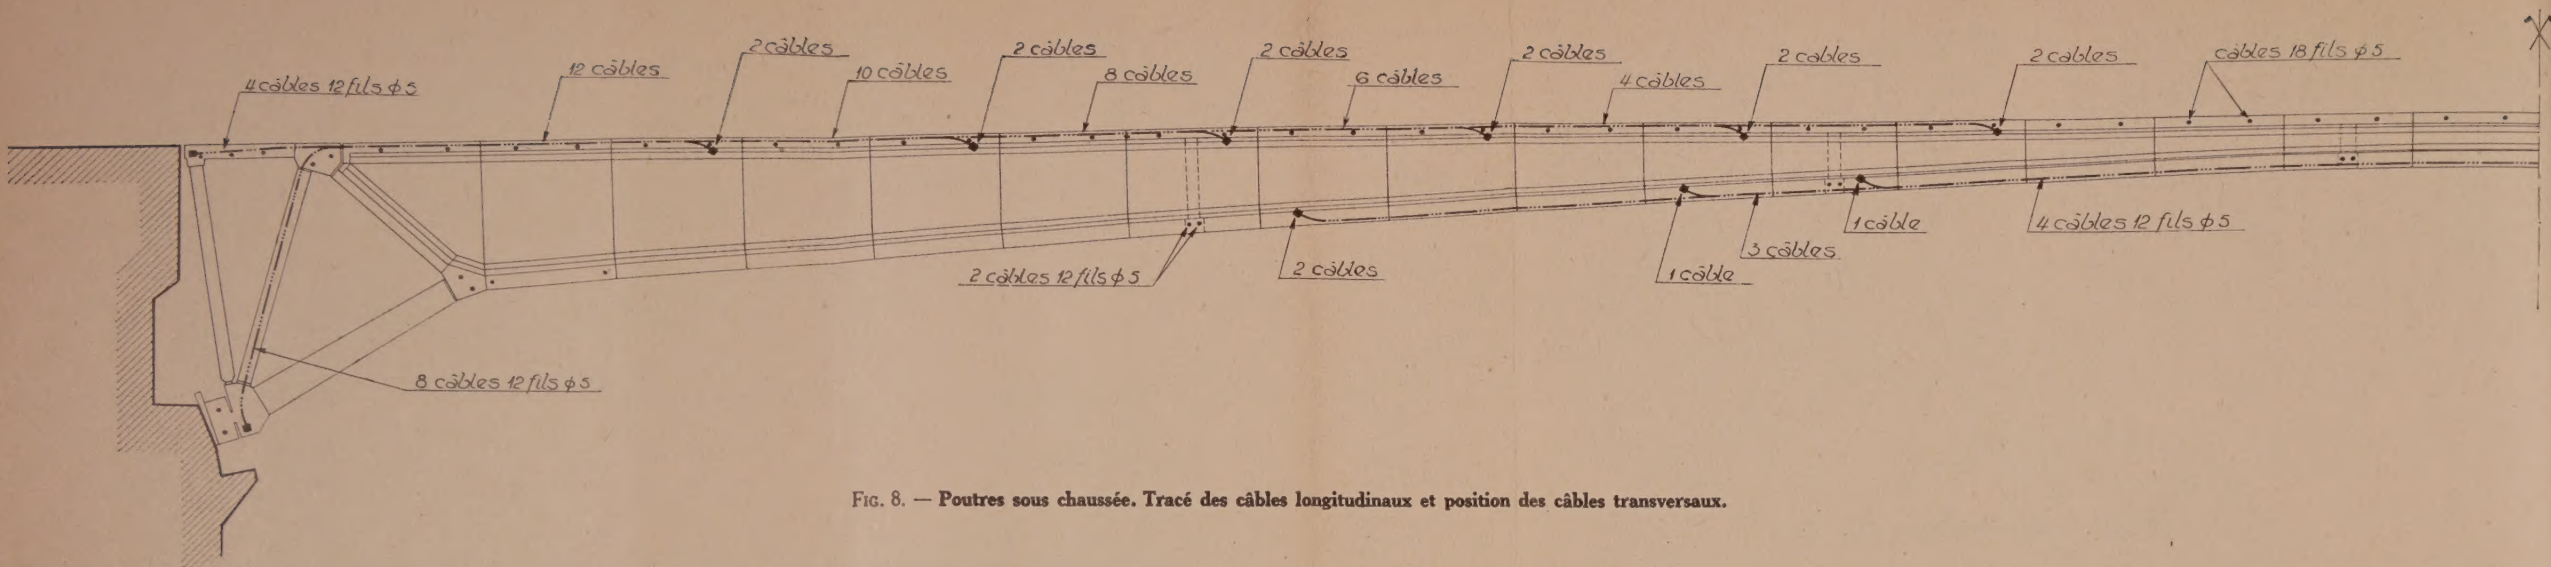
Poutres sous chaussée. Tracé des câbles longitudinaux et position des câbles transversaux.
